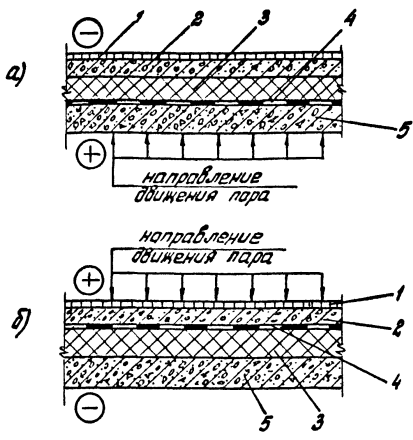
Схемы тепло-и пароизоляции междуэтажных перекрытий
